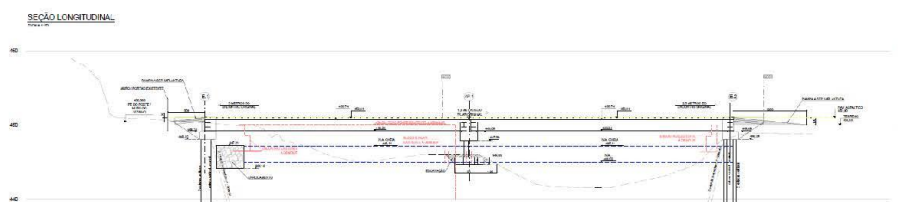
SEÇÃO LONGITUDINAL DA PONTE SOBRAGI
